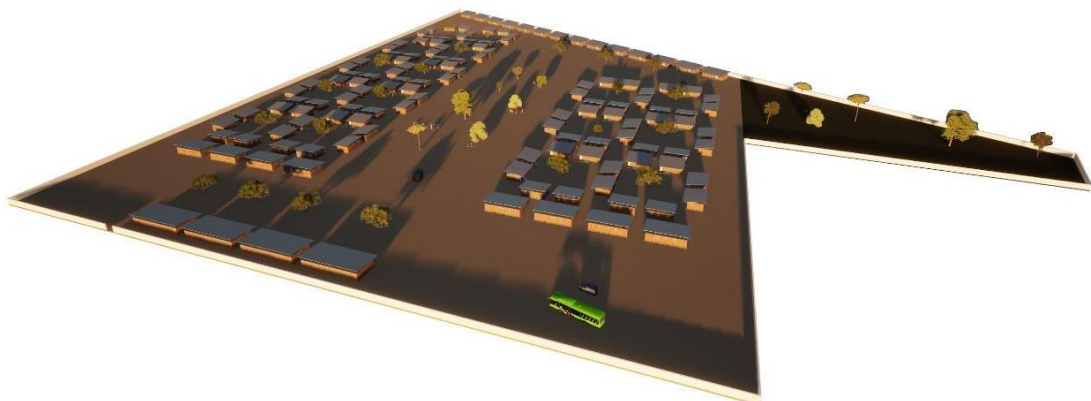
Imagem 3D do Arranjo Exterior (Fonte: Autor)
